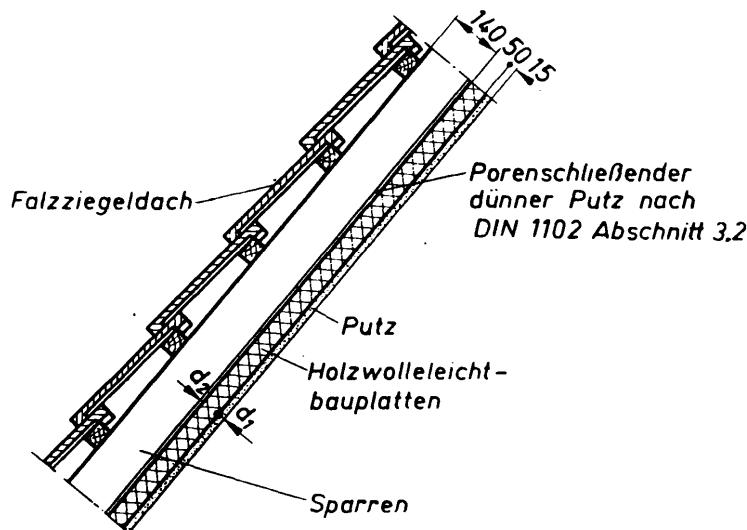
Dachschräge eines ausgebauten Dachgeschosses, mit Holzwolle-Leichtbauplatten verkleidet
